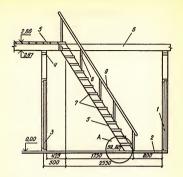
Конструкция лестницы: 1 и 3 — входная и внутренияя двери; 2 — доски пола; 4 — верхняя обвазка; 5 — тетная; 6 — балка междуэтажного перекрытия; 7 ступень; 8 — стойка ограждения; 9 — перила; 10 — прорези для ступенья;
